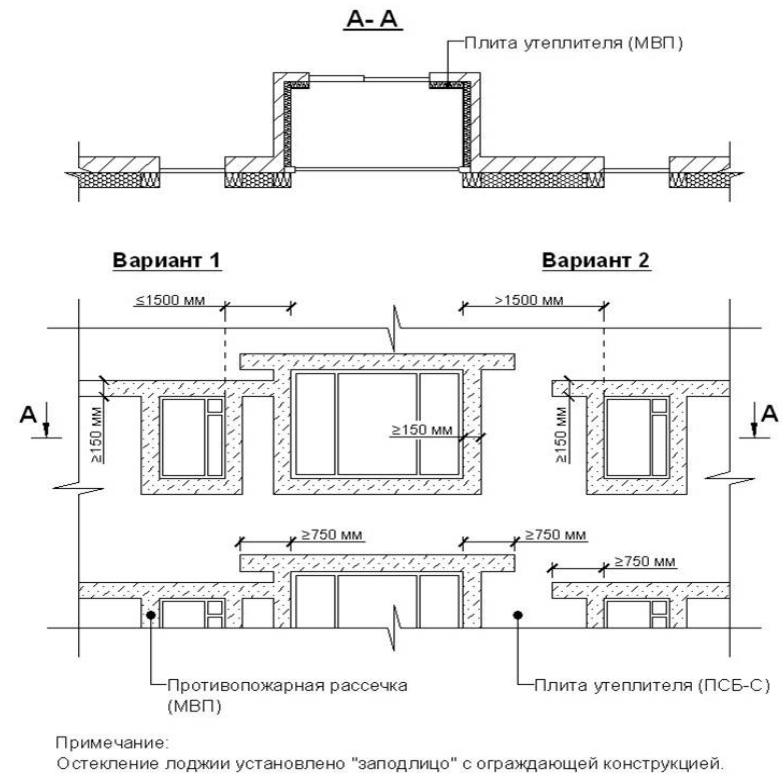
Участки наружных стен по периметру остеклённых лоджий.
